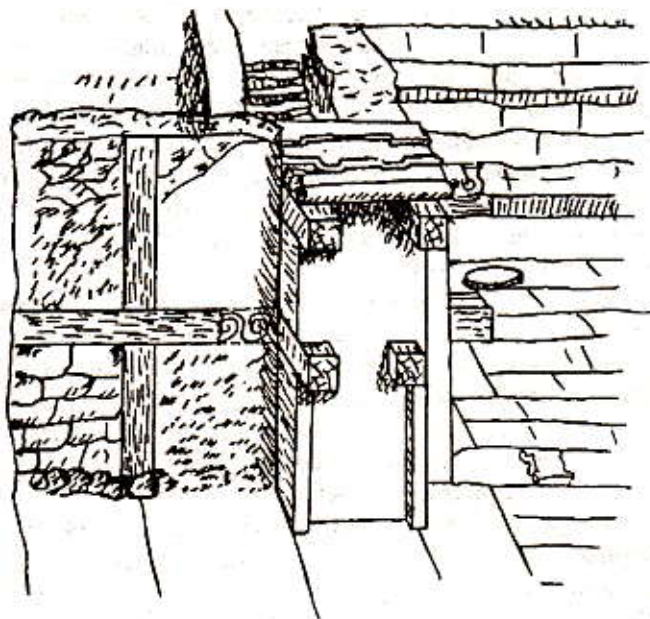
Каменная кладка, армированная деревом в Кноссе
